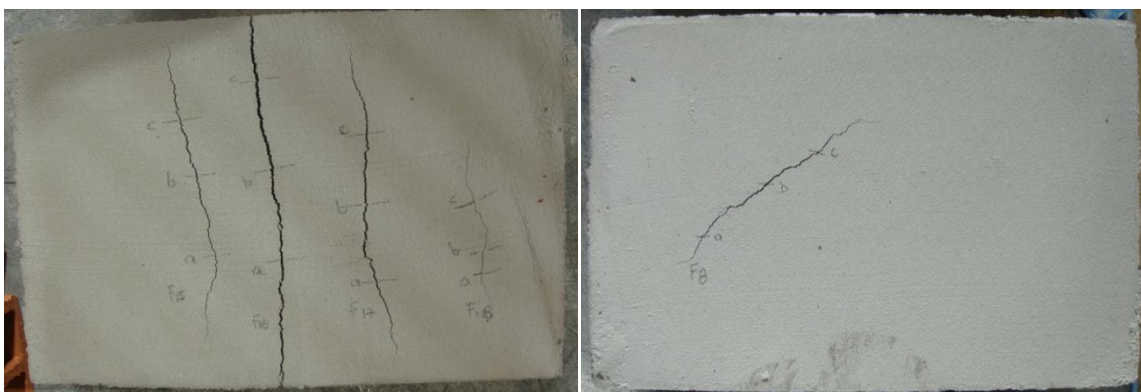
ARGAMASSA P250 CS – CURA SECA – FISSURAÇÃO
